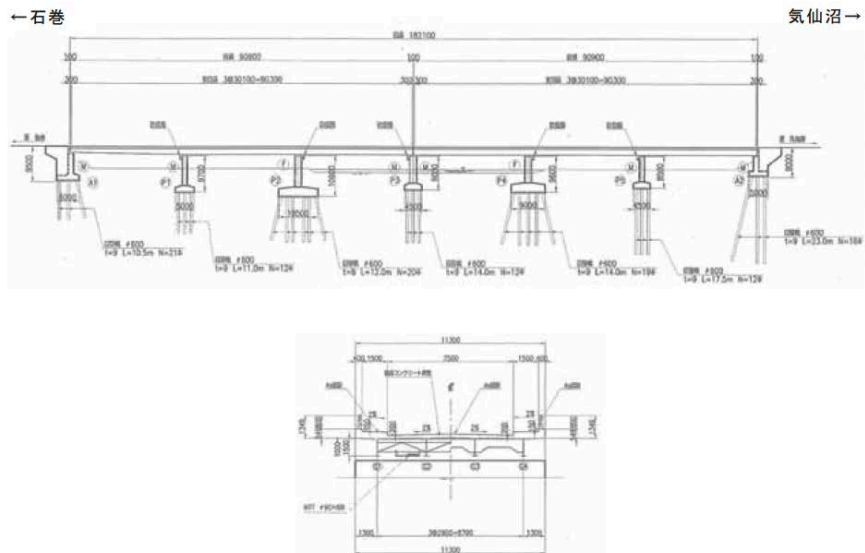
小泉大橋側面図(上)及び断面図(下)
